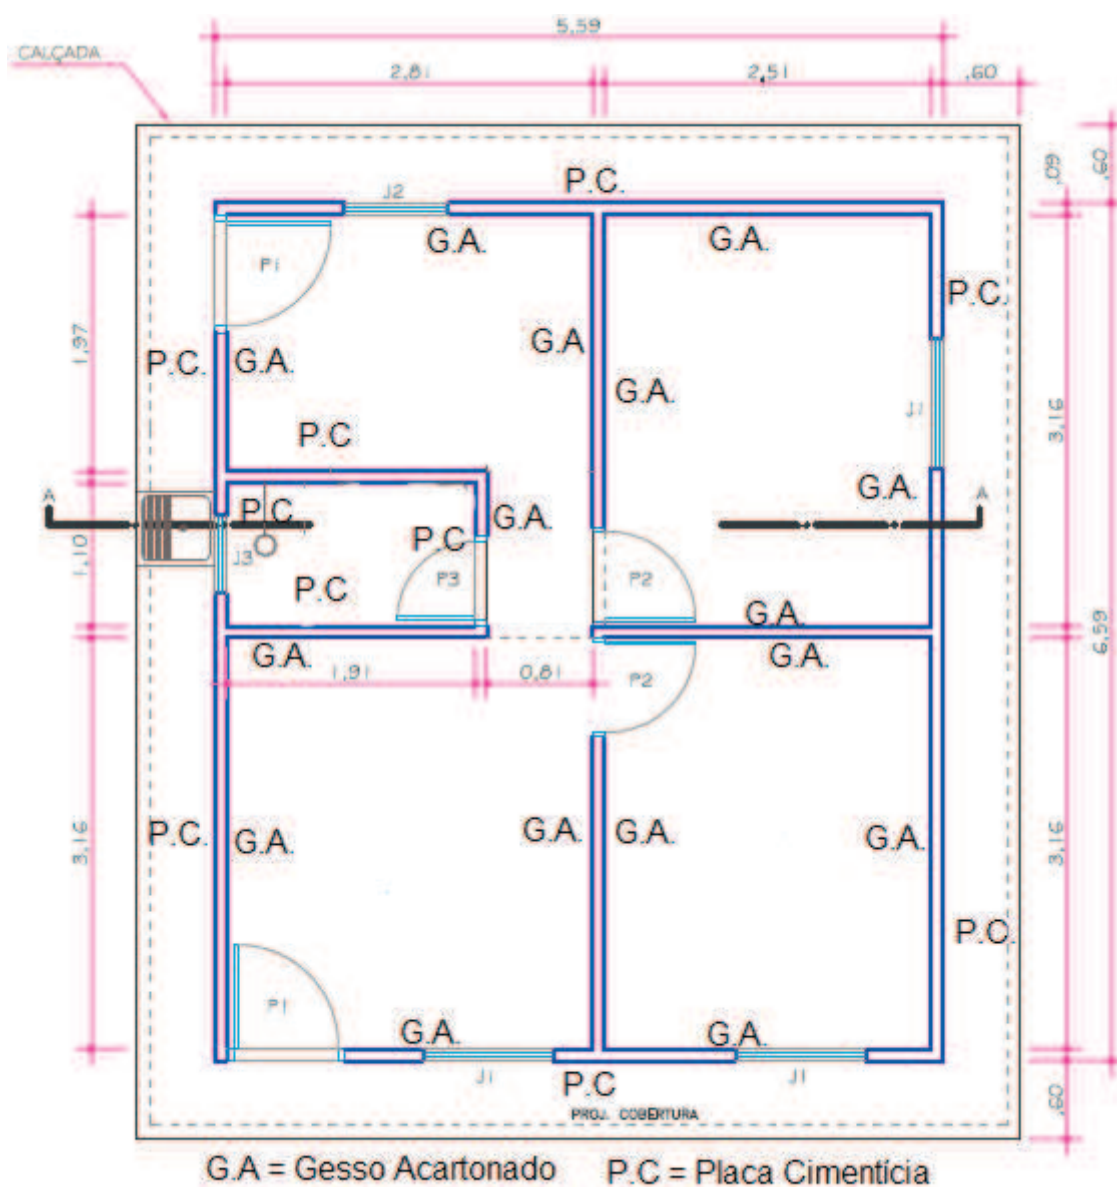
Planta baixa com detalhe das locações de revestimentos internos e externos para estrutura em LSF.
